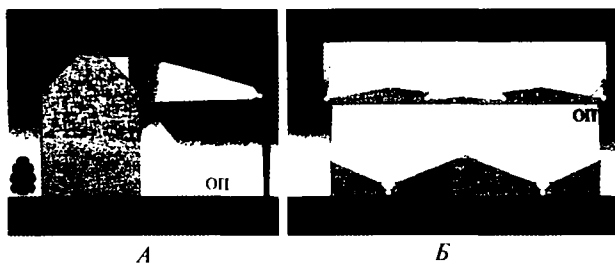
Возможное размещение прожекторов для освещения фасадов здания и кровли
